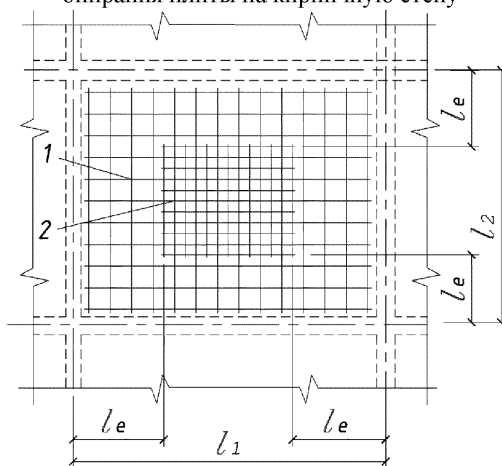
Схема армирования плиты, опертой по контуру, цельными сварными сетками: 1 – основной; 2 – дополнительной
